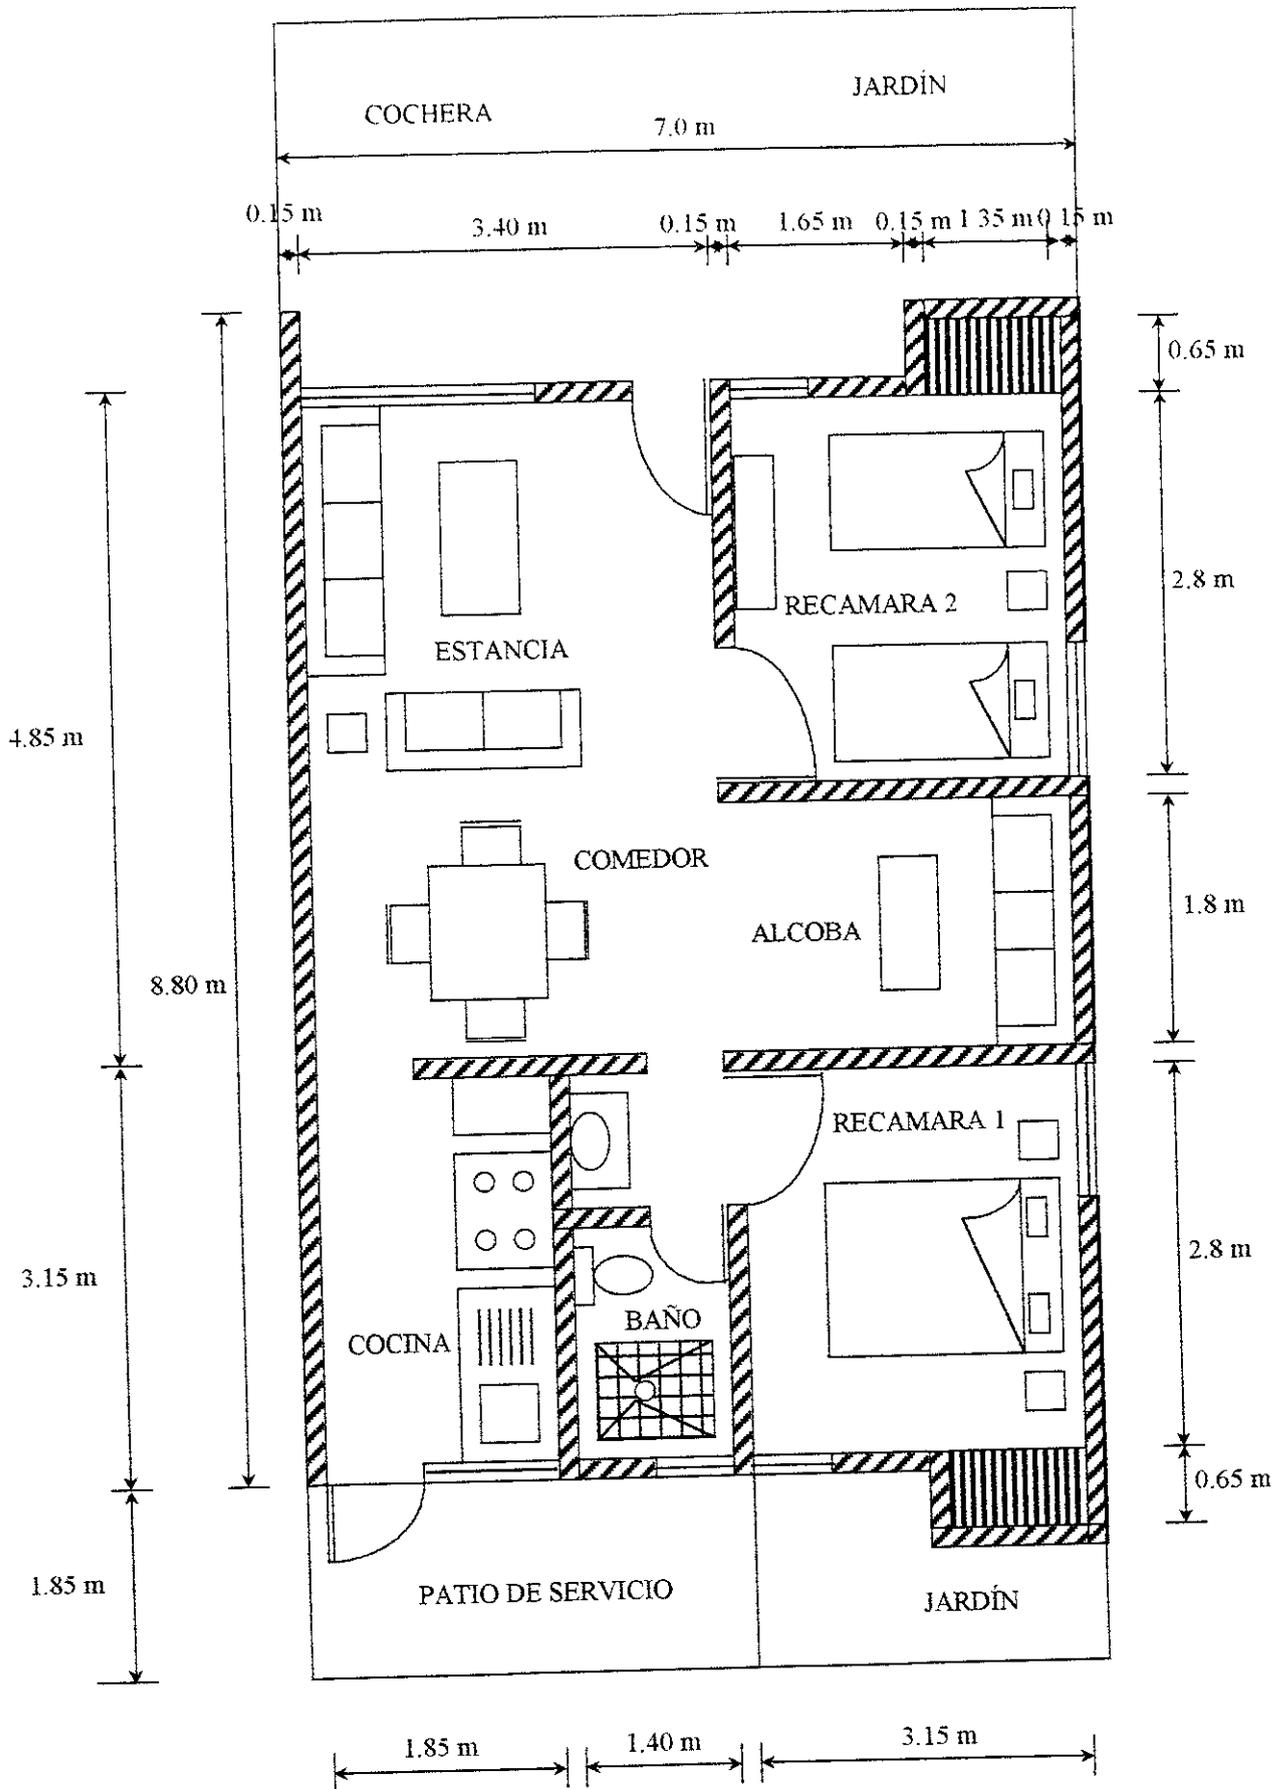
a Prototipo arquitectónico de vivienda considerando una cochera
